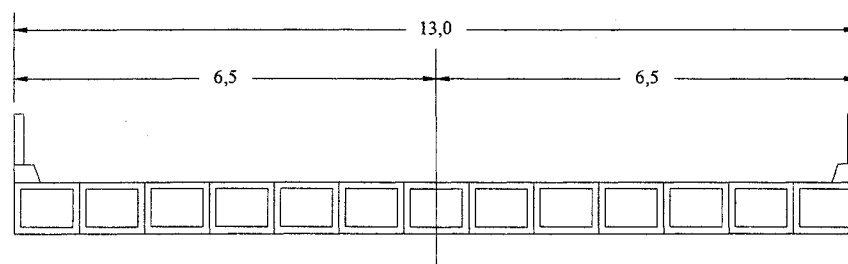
Section de pont avec des sections préfabriquées tubulaires de BFUP-150MPa
